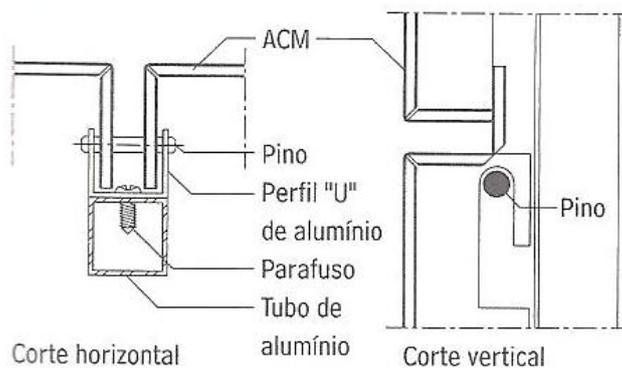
Sistema pinado – junta aberta (ventilada) (Pini, 2008)
